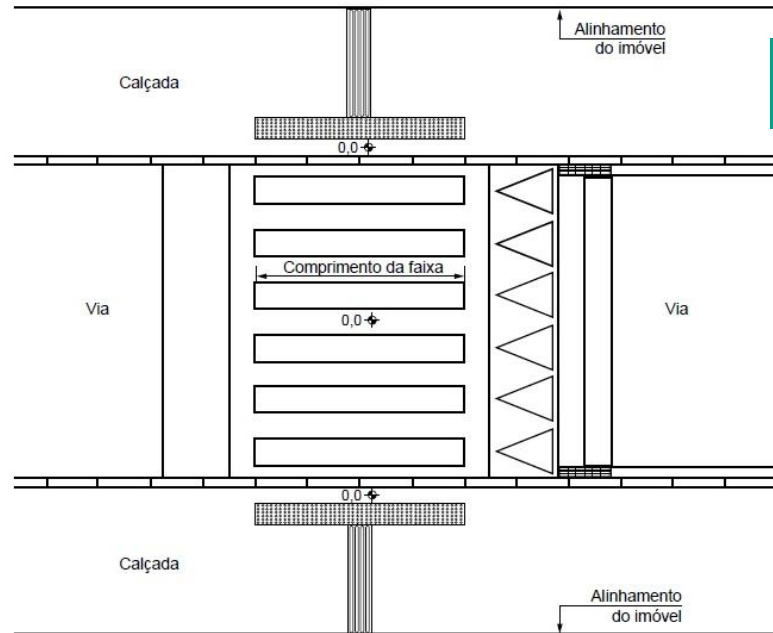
Faixa elevada para travessia – Exemplo – Vista superior
